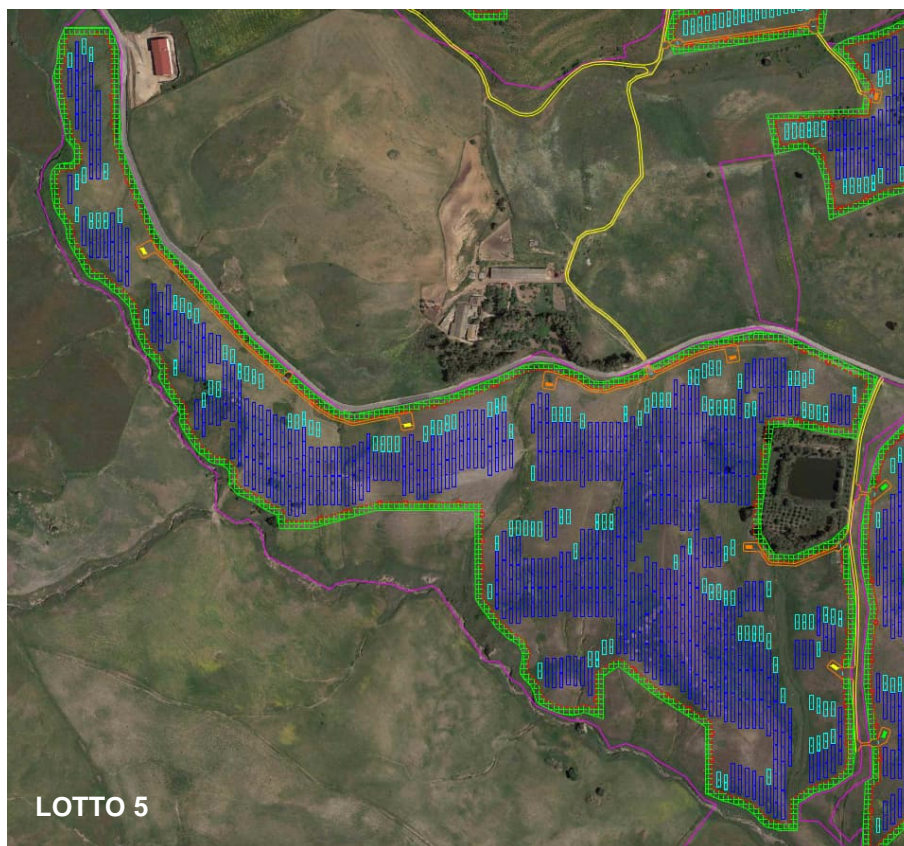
Sovrapposizione su ortofoto del layout di impianto.
